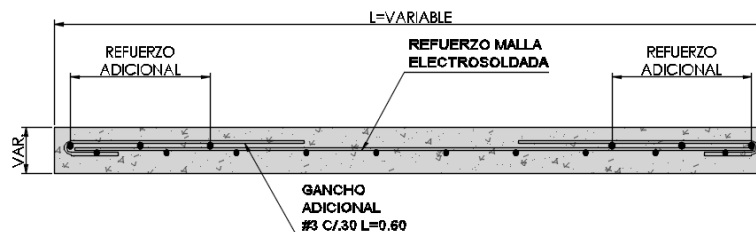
Detalle típico de muro con refuerzo adicional. Fuente: Imágenes de planos DUAL INGENIERÍA ESTRUCTURAL SAS. Archivo personal, recuperado en el 2017.
